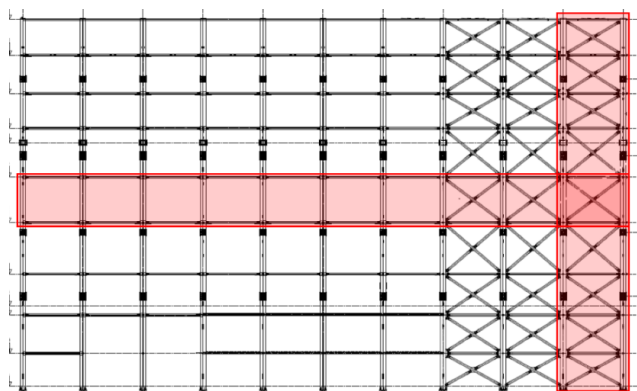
Alzado longitudinal esquemático de la estructura principal.
